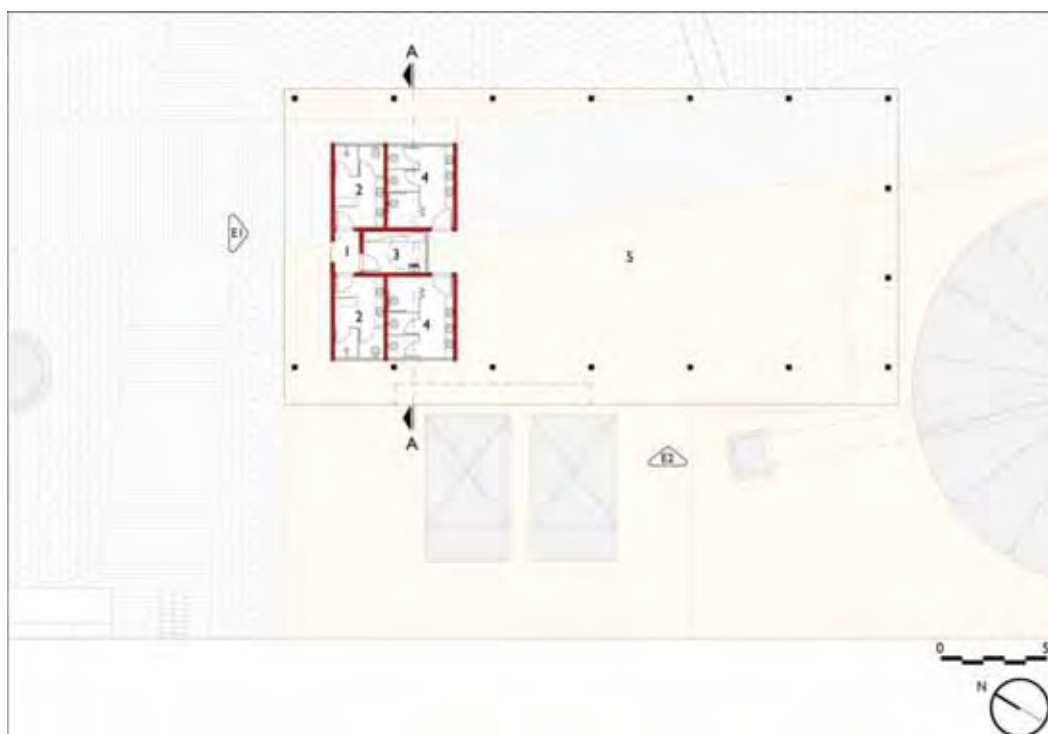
Planta do edifício de apoio. (Desenho da autora.)
